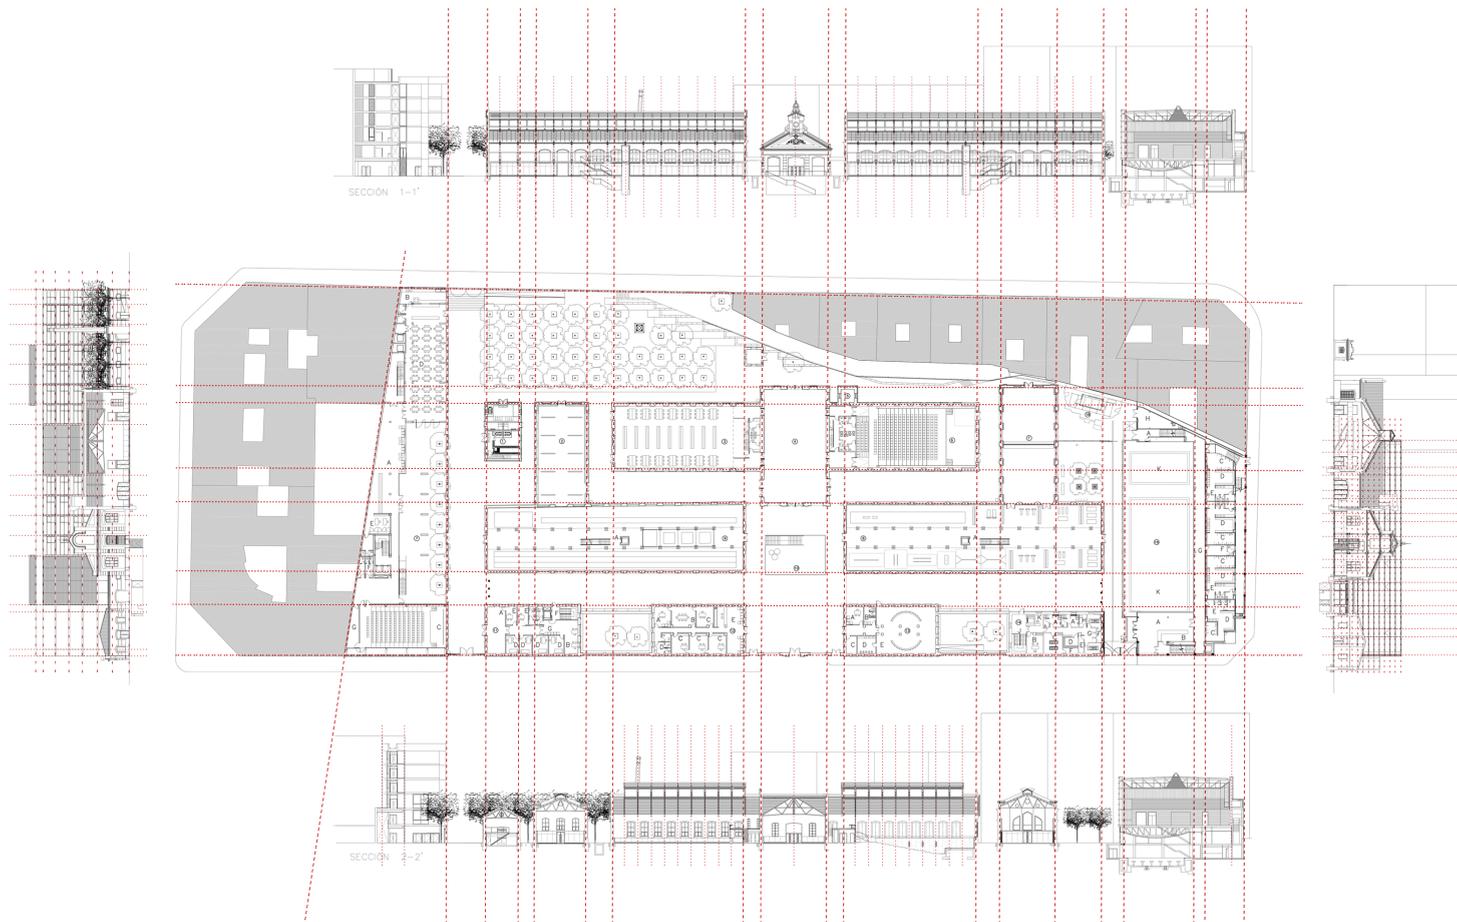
| Planta baja del La Petxina y Alzados norte, sur, este y oeste junto con el análisis compositivo.
